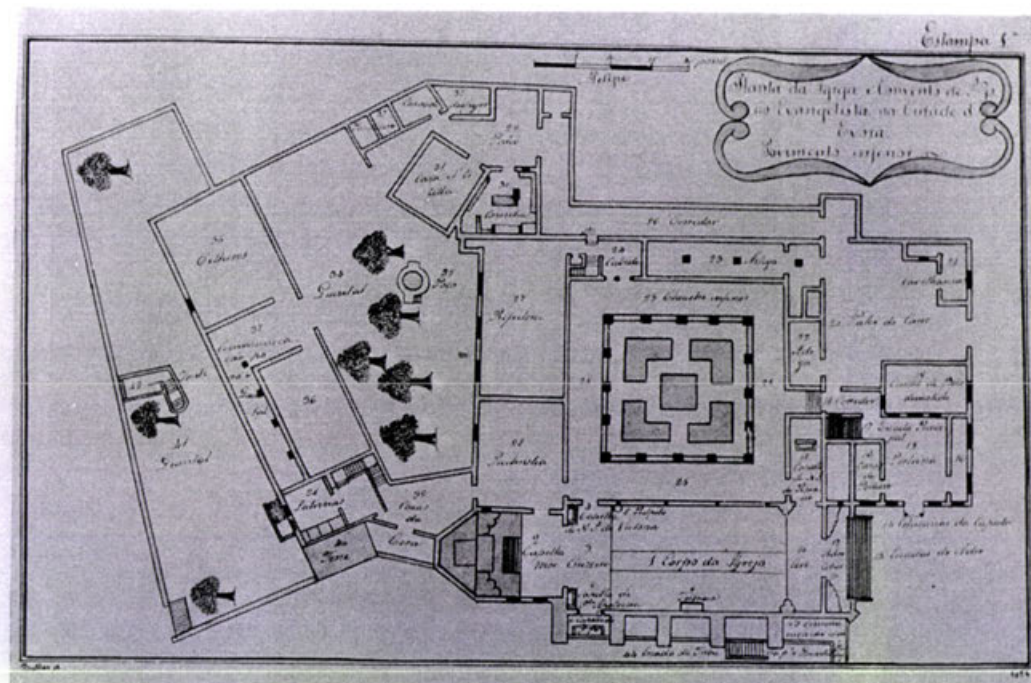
Planta antiga do piso térreo do Convento, e sua cerca.
